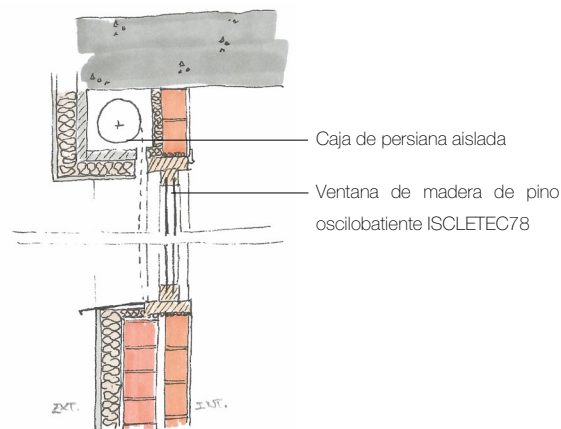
Detalle constructivo del hueco de ventana con caja de persiana y con el sistema SATE de aislamiento aplicado (autoría propia).
